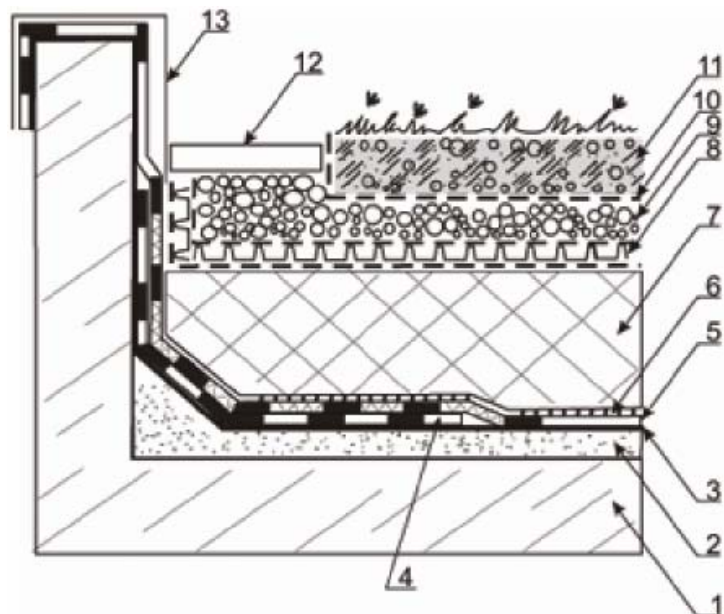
Примыкание кровли к парапету для инверсионной системы (Эксплуатируемое покрытие)
